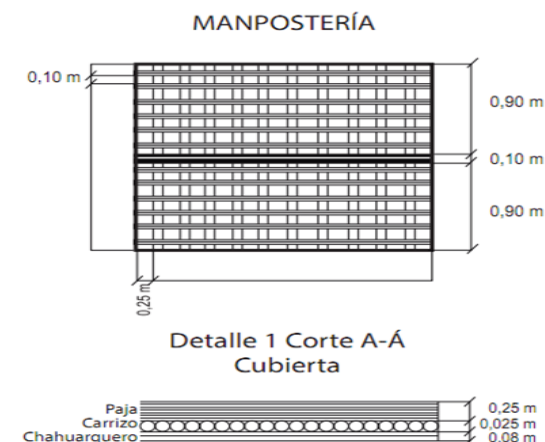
Detalle de muro-cubierta. Elaboración: Autora y equipo de apoyo.
